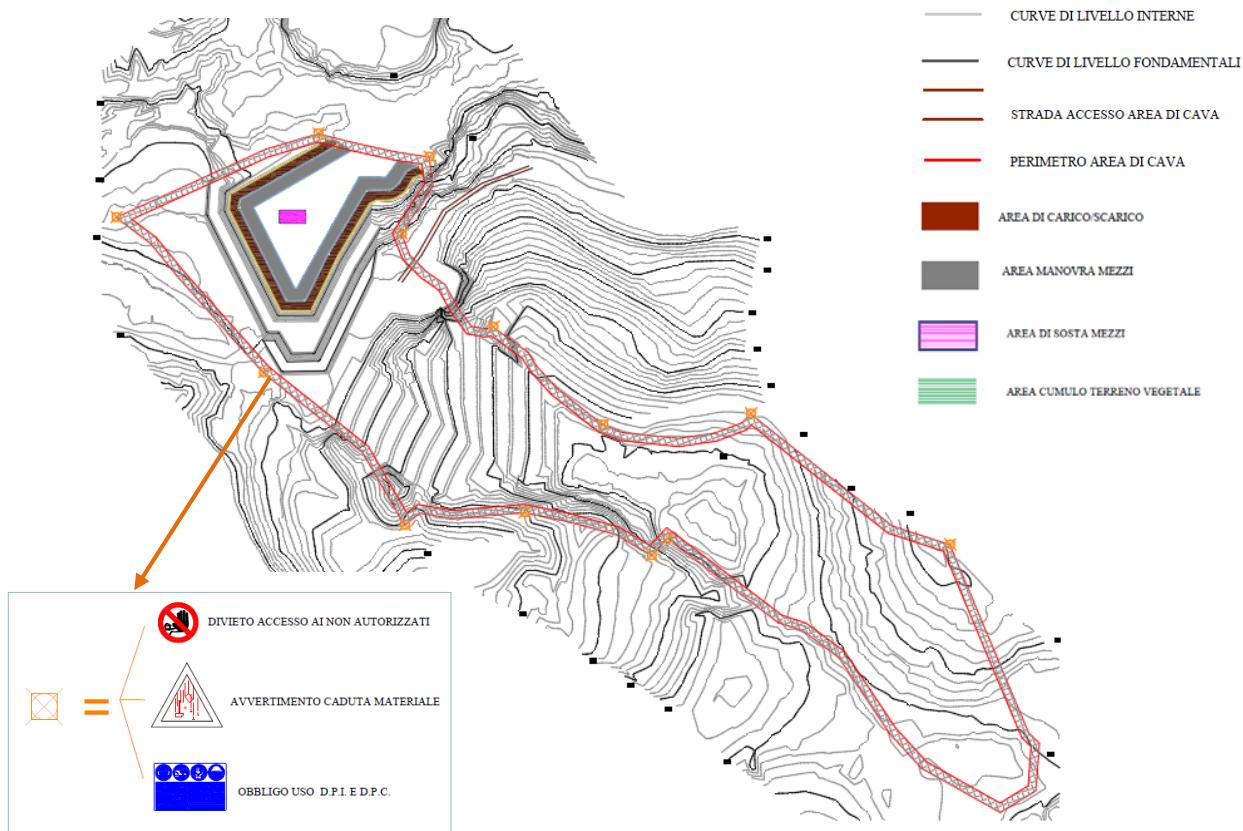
STRALCIO CANTIERIZZAZIONE 2° STADIO DI COLTIVAZIONE
